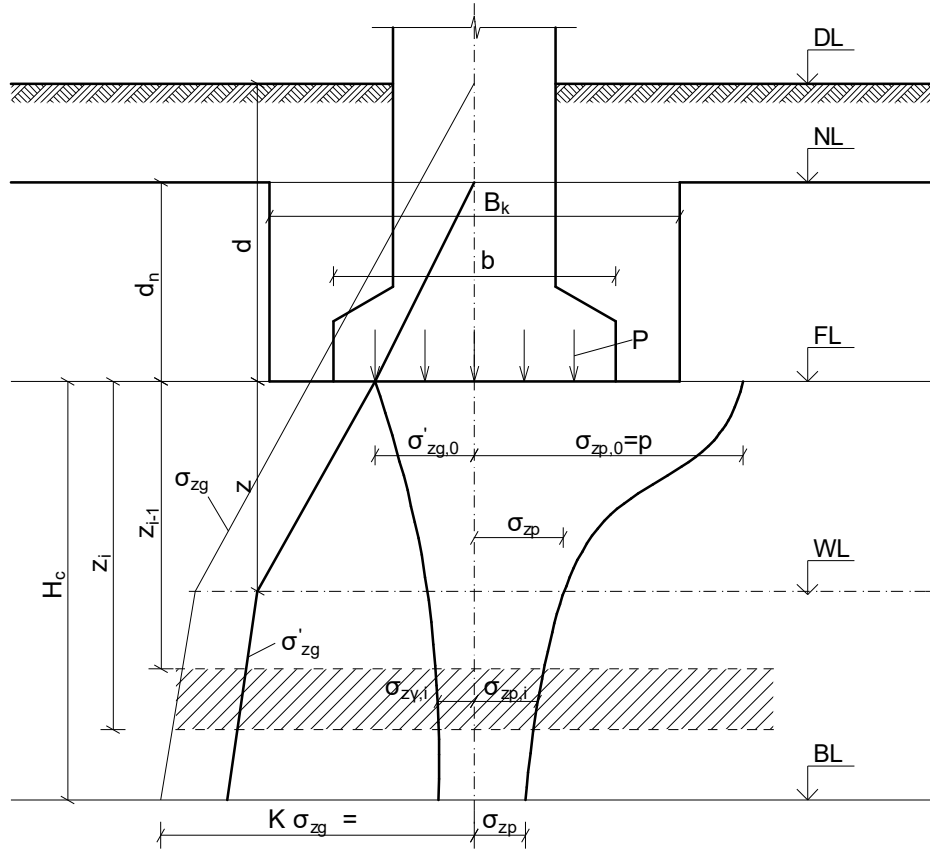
Епюри напружень під підшовою фундаменту за методом пошарового підсумовування
